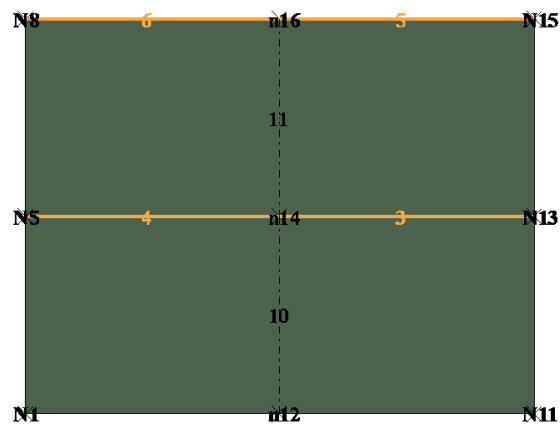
Prospetto Parete 2 - Modello Collegato
